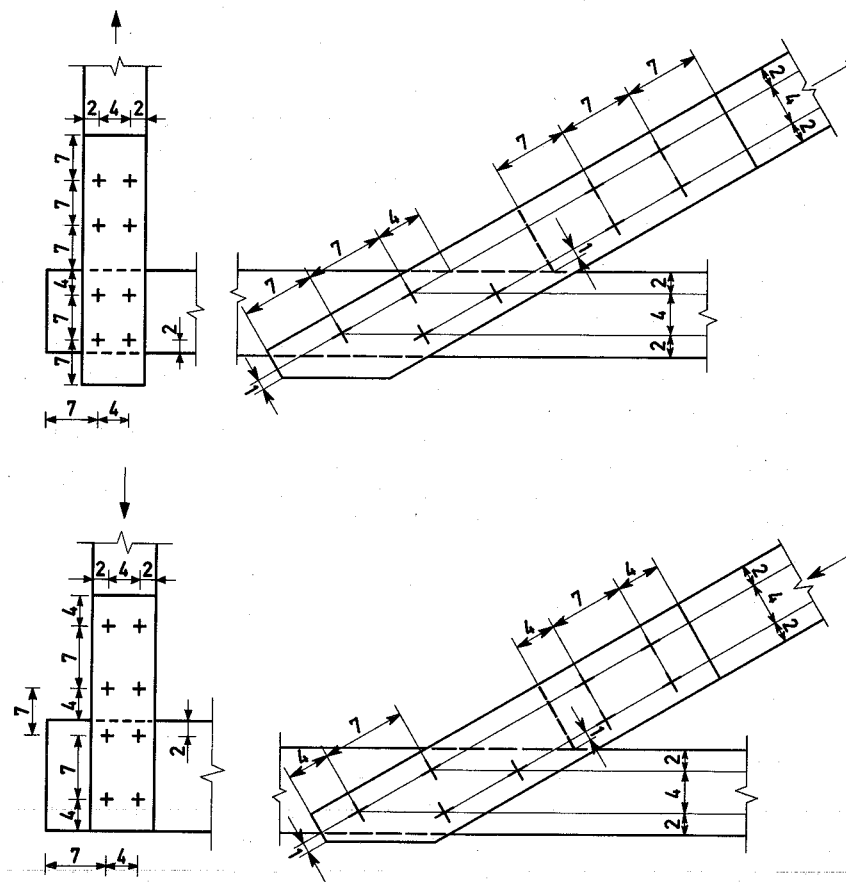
Mindste bolteafstande er de angivne tal gange boltediameteren d .
